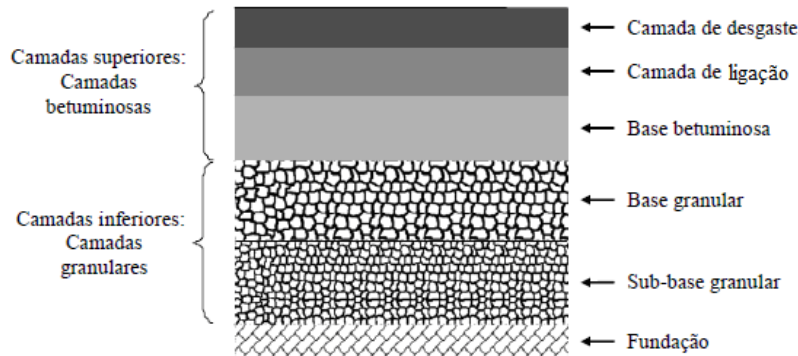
Constituição de um Pavimento Flexível (Fonte: Lopes, 2009)
